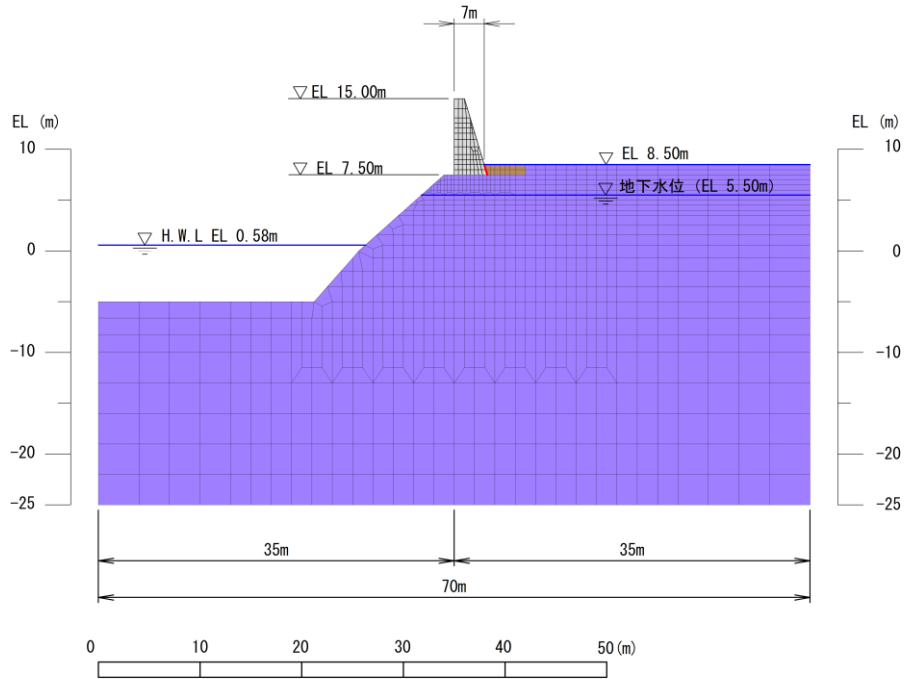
地震応答解析モデル (⑤-⑤断面)
